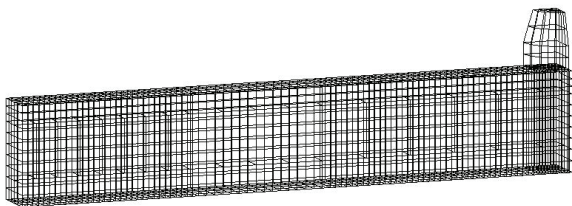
解析モデル (対象性を考慮した 1/4 モデル)
